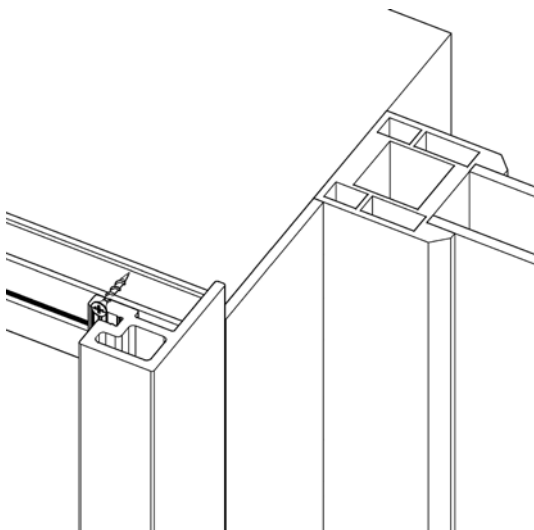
Montaje de la fachada en la sección inclinada del portal. Vista desde arriba
